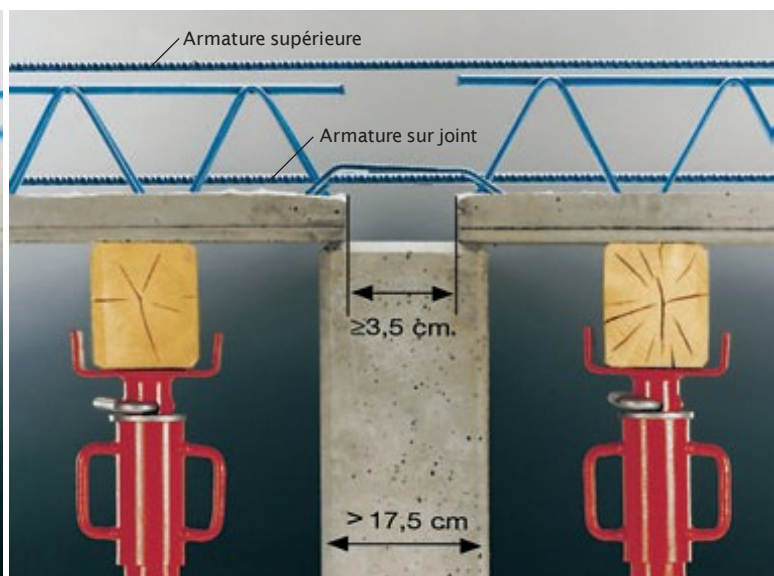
prédalle sur un mur de refend $>17,5$ cm
